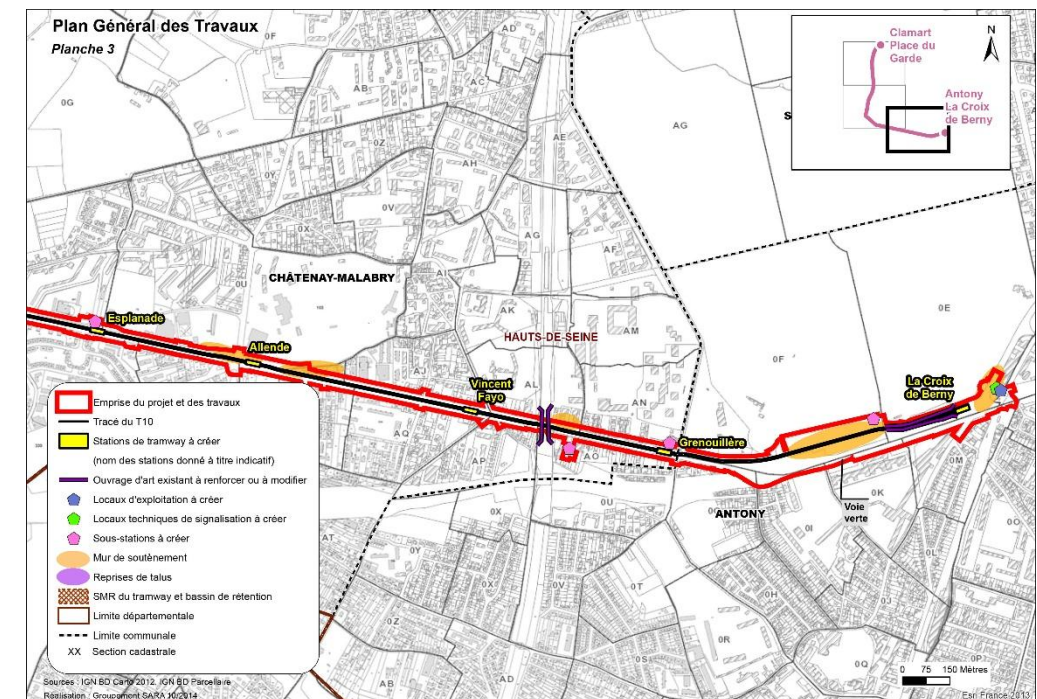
Principaux travaux et ouvrages du projet de Tramway T10 (3/3)
